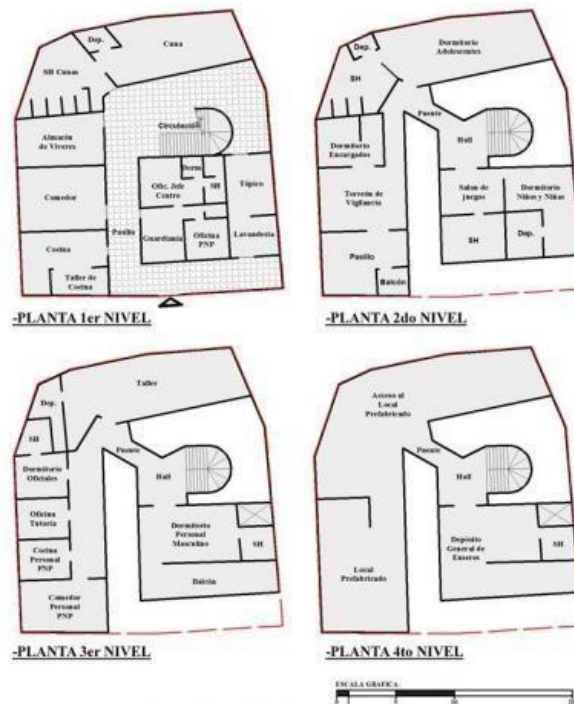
Planta de distribución del Centro Preventivo de niños y adolescentes
